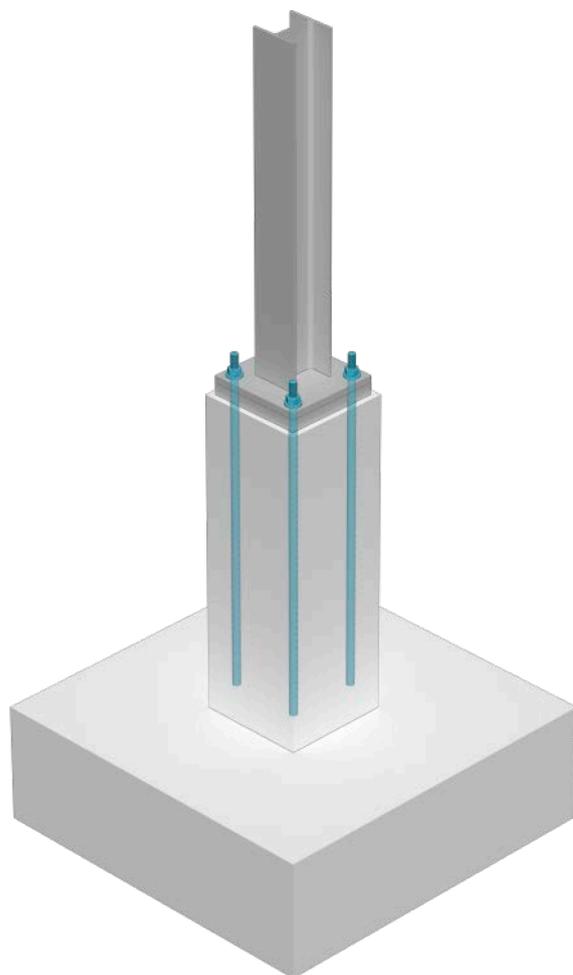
Conexión con tornillos de anclaje HPM® P de pilar metálico a pedestal de cimentación.
